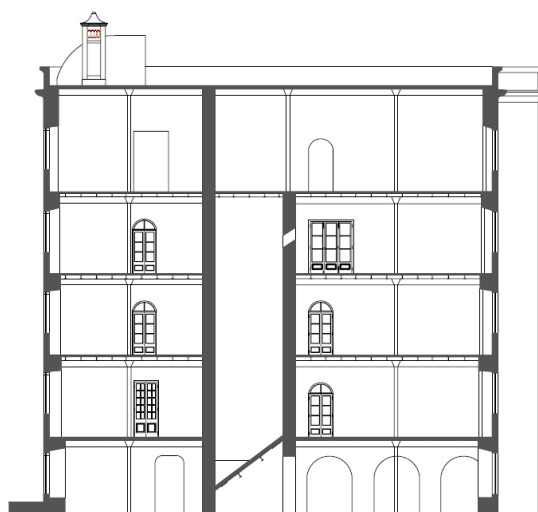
Corte longitudinal da fachada este de *A Portuguesa*¹³⁰
